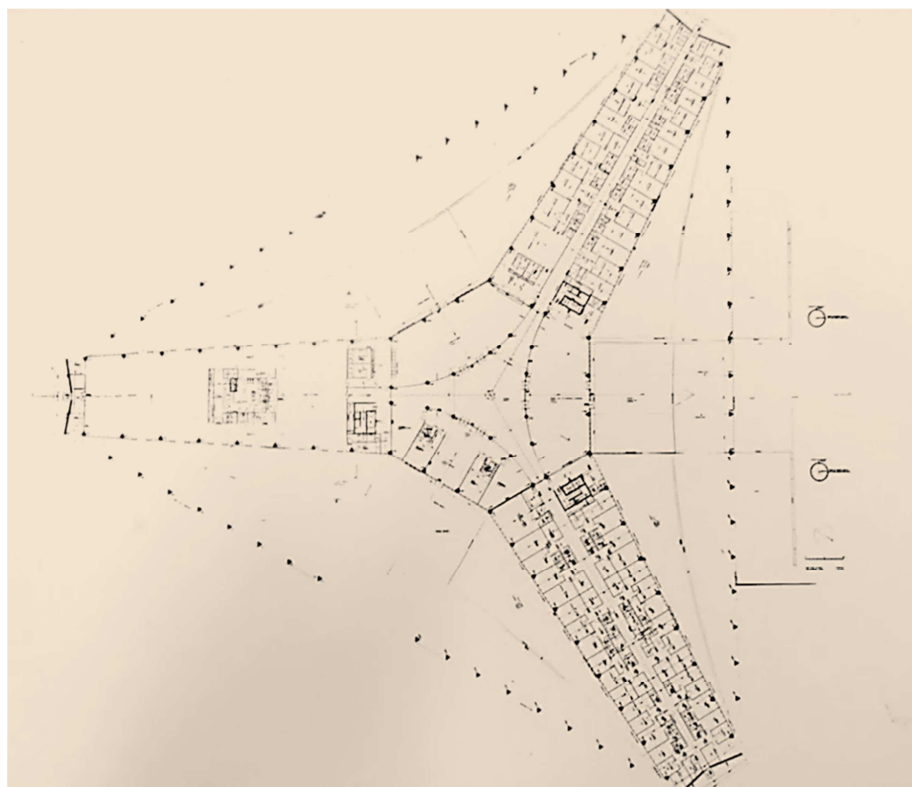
Sergio Bernardes, ESG, DF, 1970/74. Planta 1º Pavimento (Nível 00).
